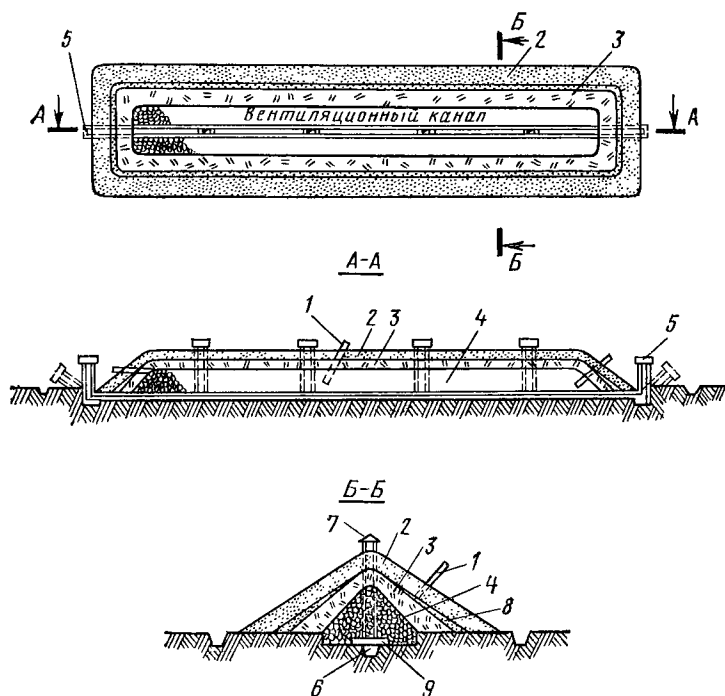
План и схематический продольный и поперечный разрезы бурта с вентиляционными трубами:
